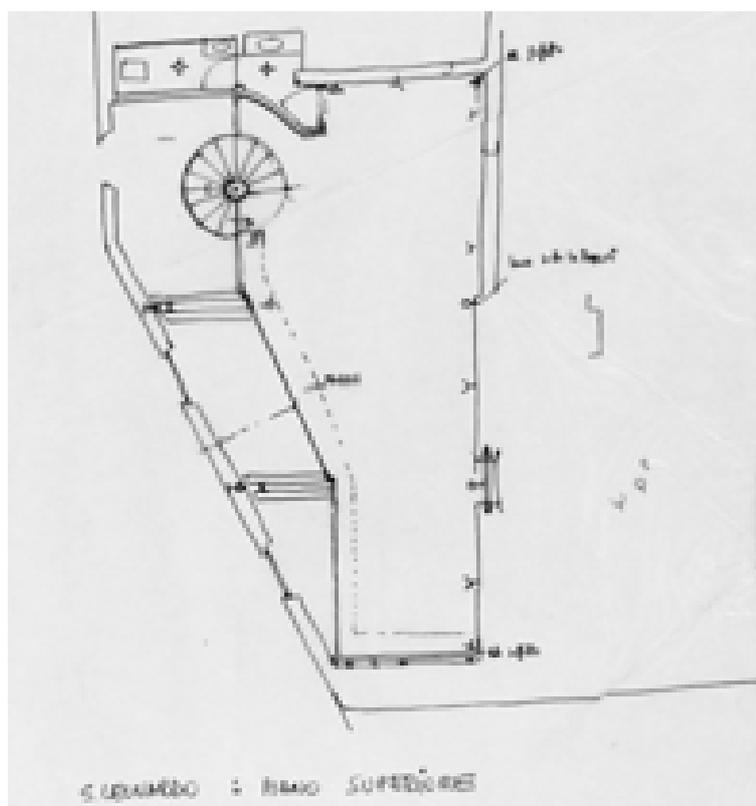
Studio pianta quota superiore – s.d. (AABS-94.188)
